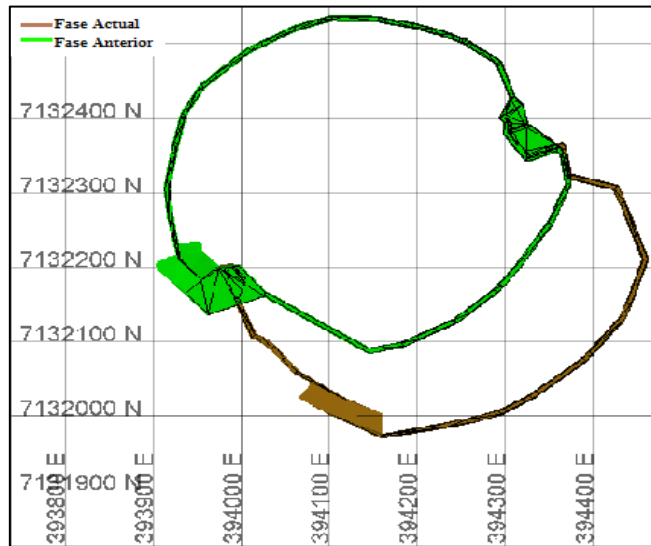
LGMM1Y Fase 6 - Vista en sección - Planta banco 1090
